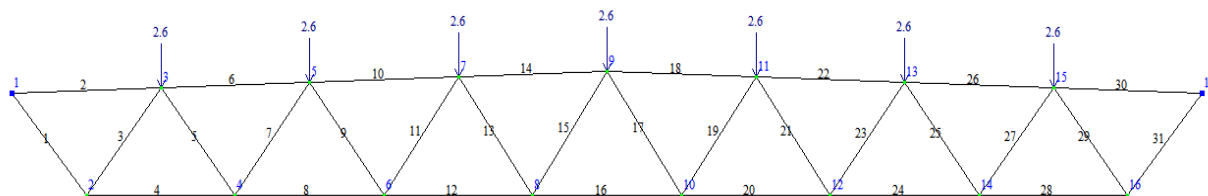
Загрузка 3 (от пирога кровли)
